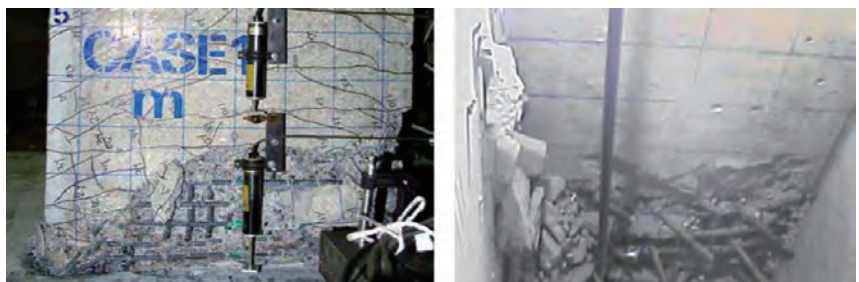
中空断面RC橋脚の損傷状況
